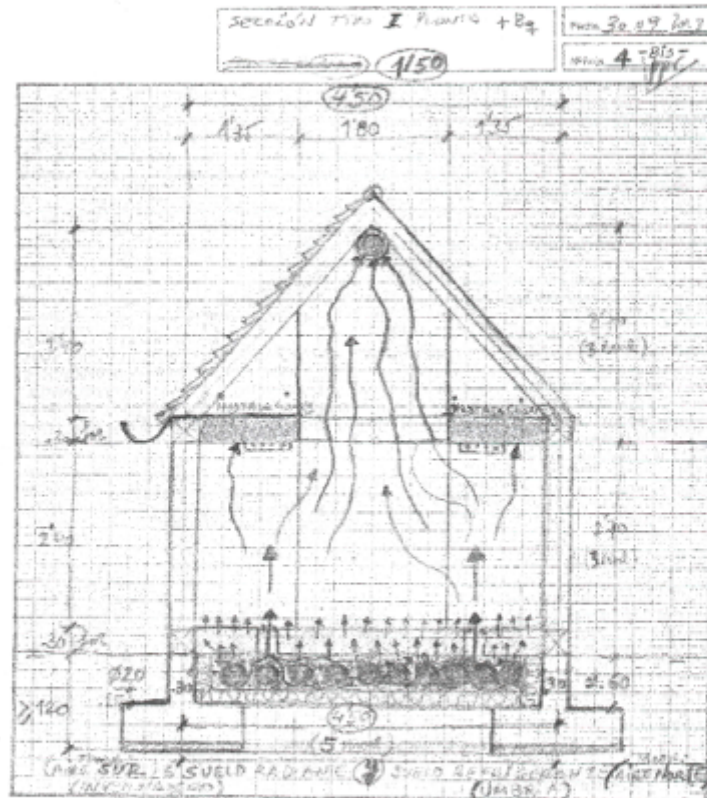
/ 4: Croquis previos de sección acotadas del prototipo seleccionado desarrollado en planta baja, más altillo bajo cubierta.
